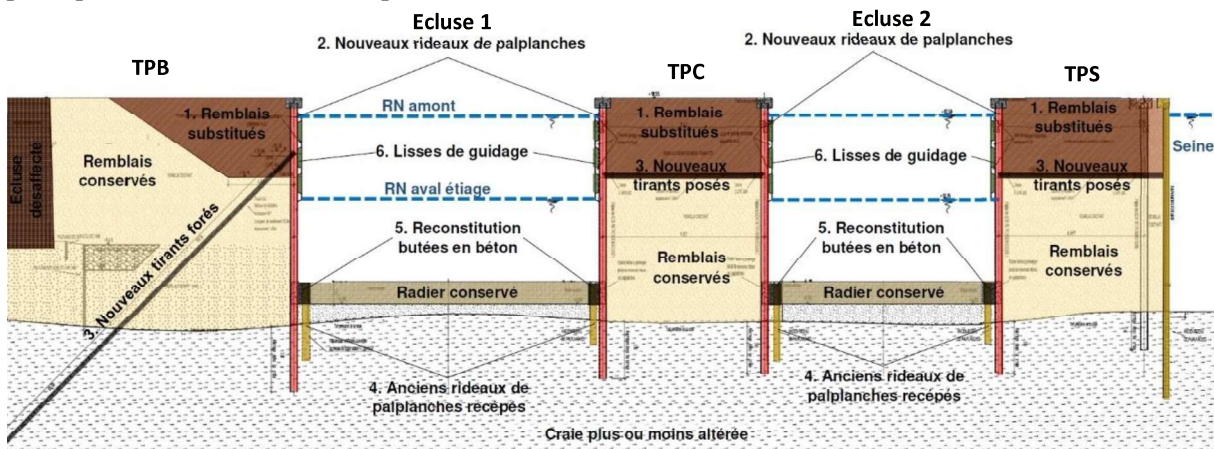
Profil en travers des sas après travaux (source : BRL)
